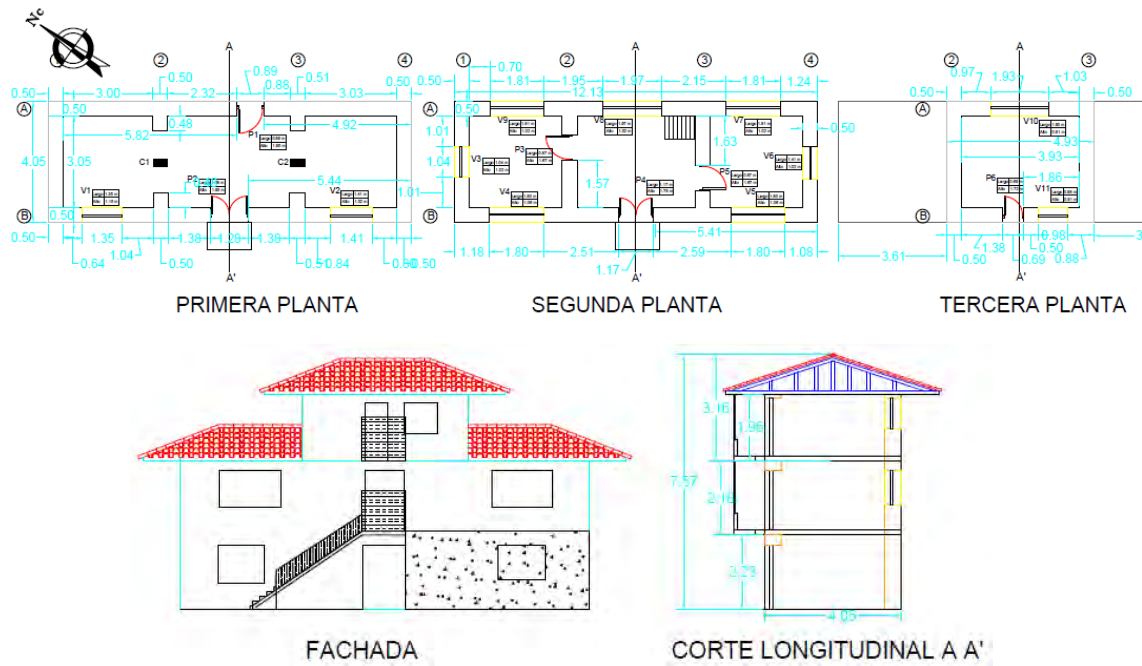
Plano en planta y elevación de la vivienda N° 05, ubicada en la zona A. Fuente: Elaboración propia, 2019.
